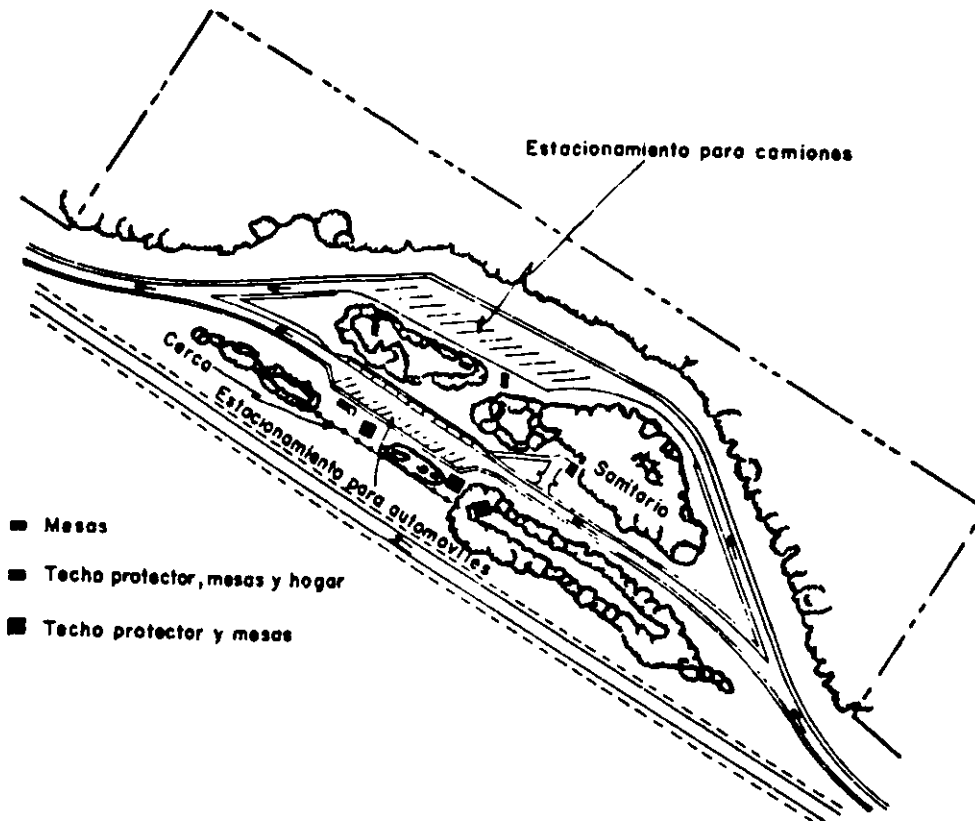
ZONA DE DESCANSO CON DOS AREAS SEPARADAS DE ESTACIONAMIENTO INTERFERIENDO LO MENOS POSIBLE CON LA VEGETACION EXISTENTE
